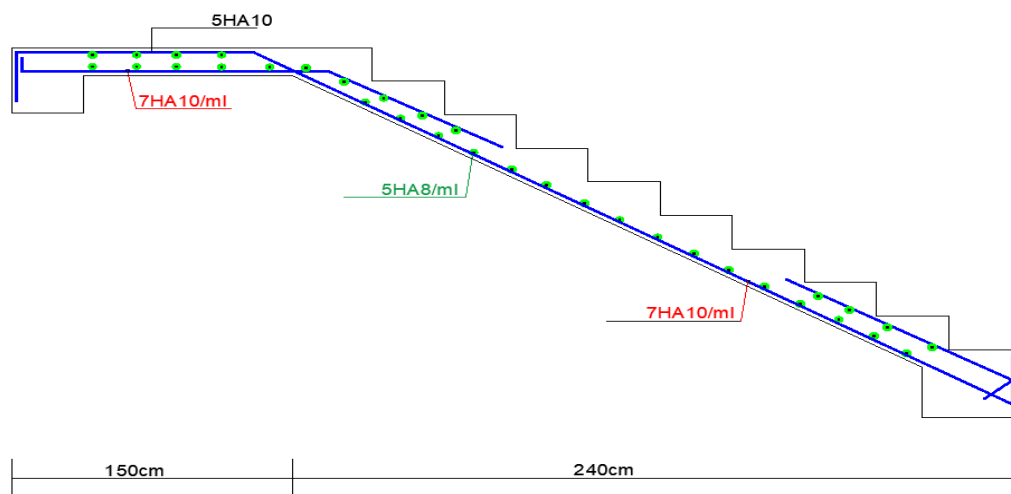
Schéma de ferrailage des escaliers selon le CBA 93.
